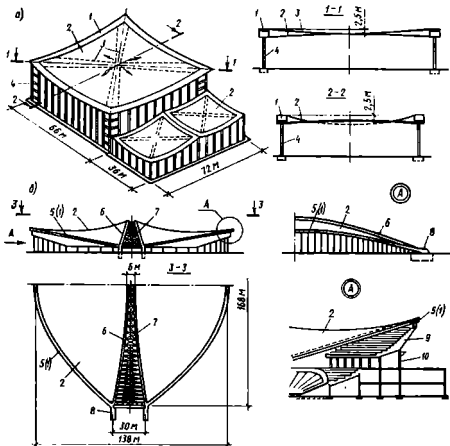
Мембранные покрытия, деревянные висячие покрытия:
